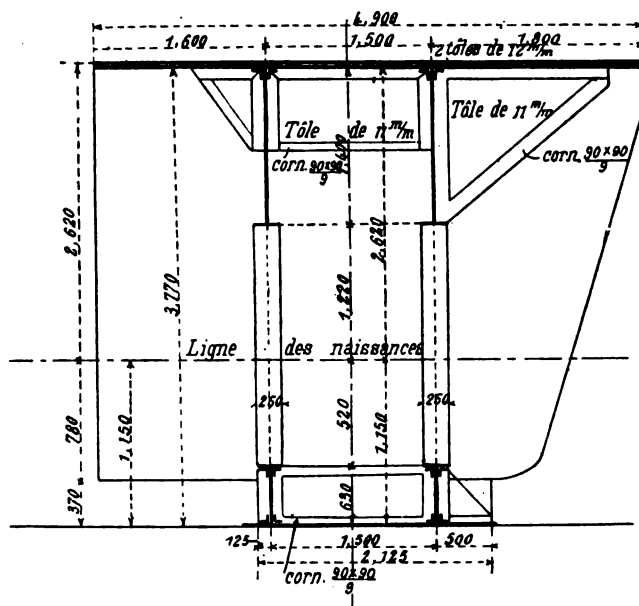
Bouclier Wéber : coupe longitudinale.
